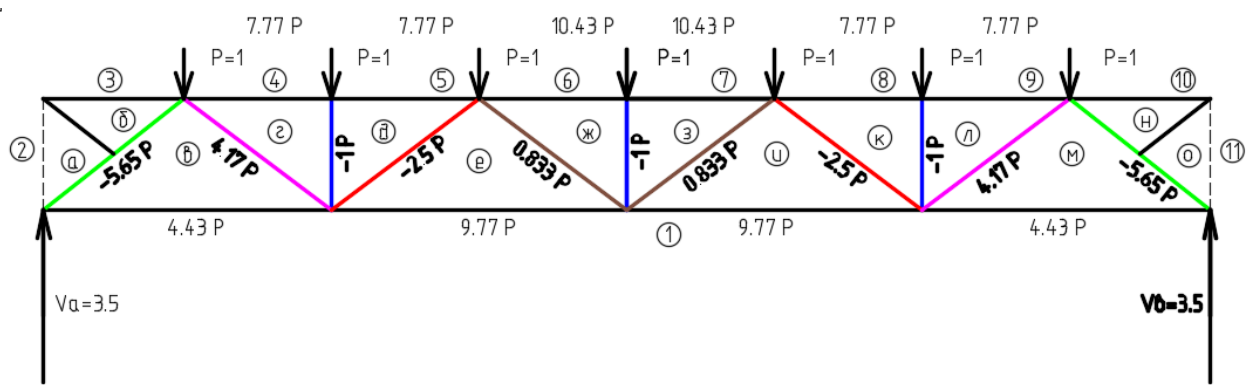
усилия в стержнях фермы от расчетных нагрузок.
